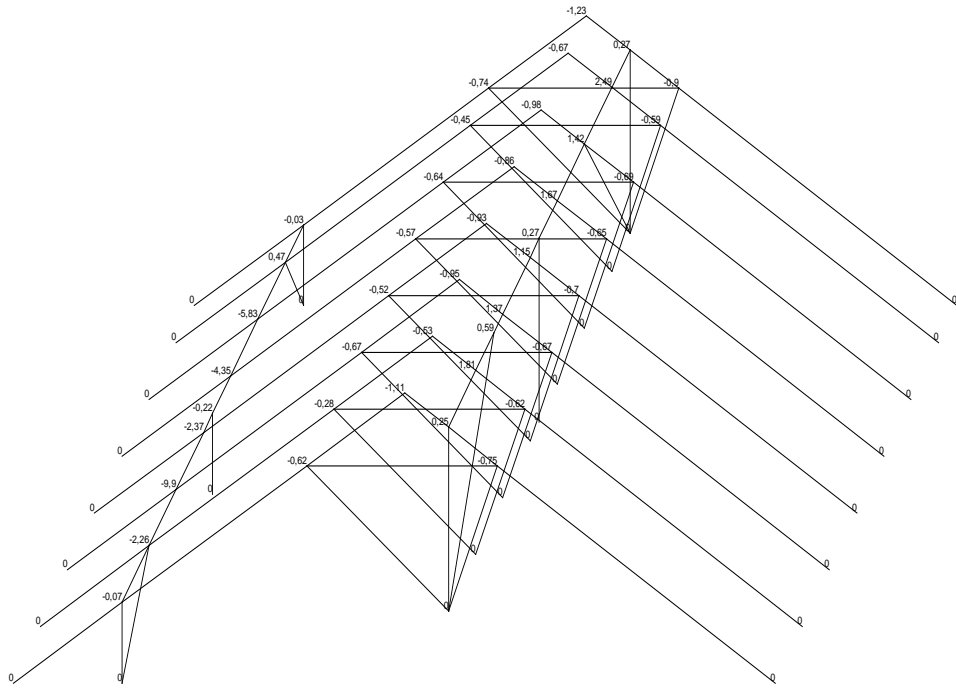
Вертикальные перемещения узлов фрагмента стропильной системы от расчетных нагрузок (мм)
